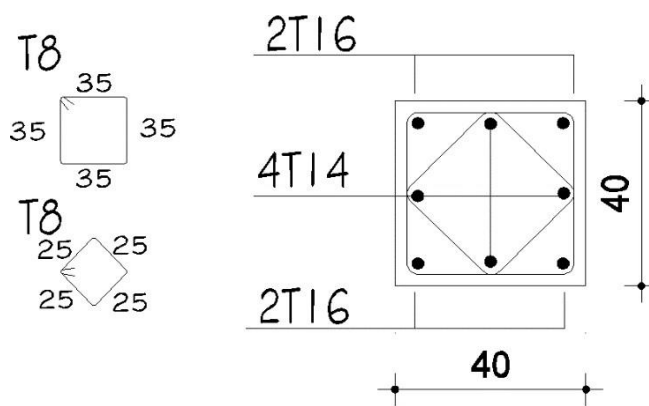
Dessin de ferrailage de poteau (40×40).
